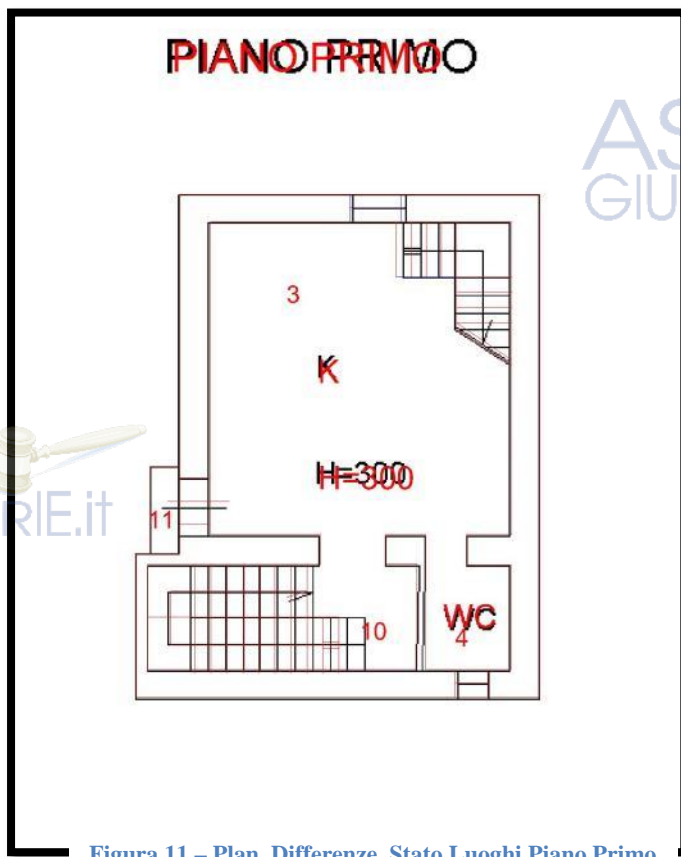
Plan. Differenze Stato Luoghi Piano Primo
